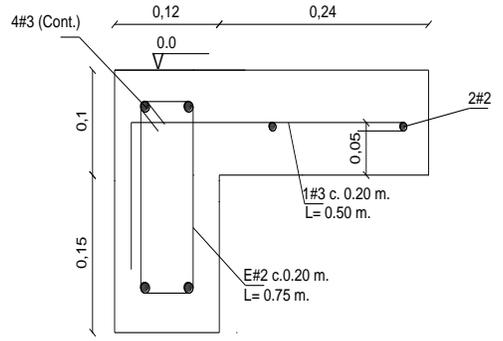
ARMADO DE HIERRO VIGAS DE CIMENTACION
